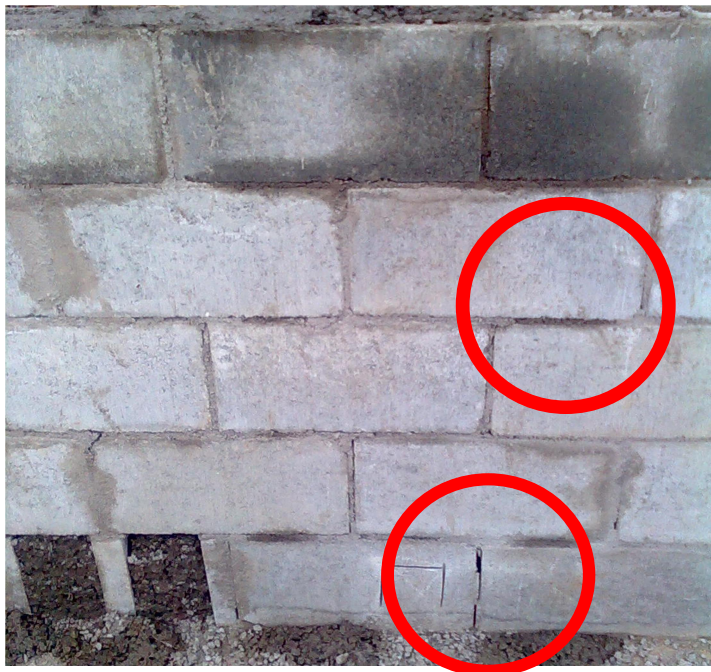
Falhas em juntas horizontais e verticais (Silveira, 2016)
